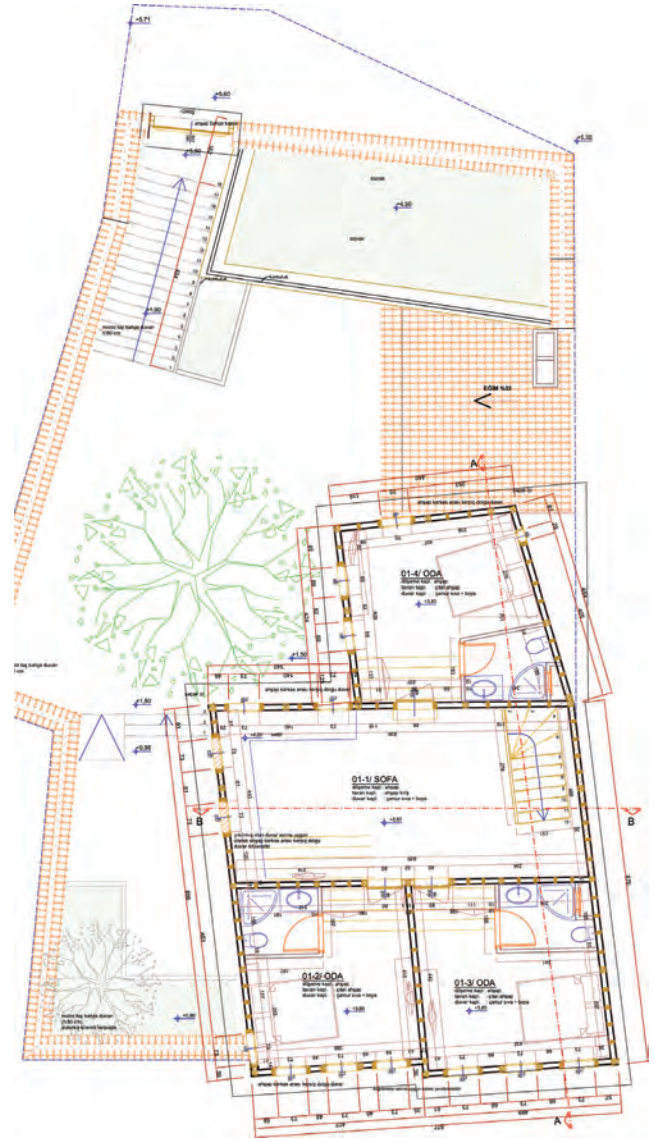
Ara kata ait restorasyon planı / Restoration plan of the mezzanine (winter floor)
